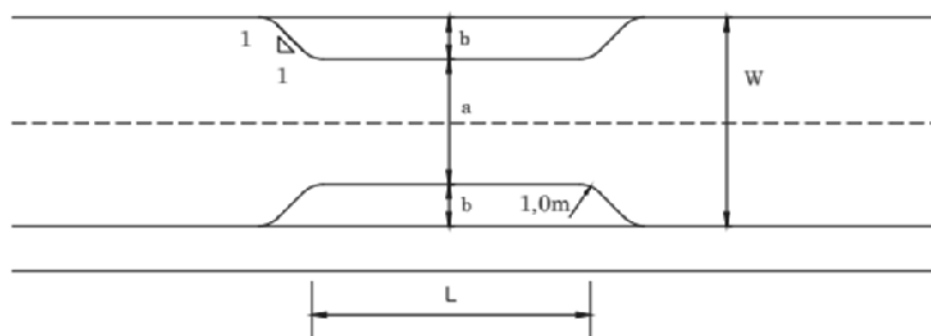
Planta de Estrangulamento a partir dos lados em vias largas
